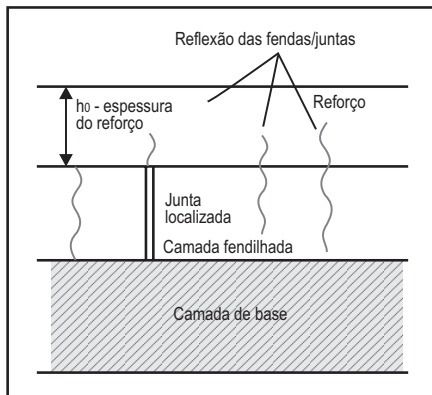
Propagação do fendilhamento pelo reforço de pavimento
